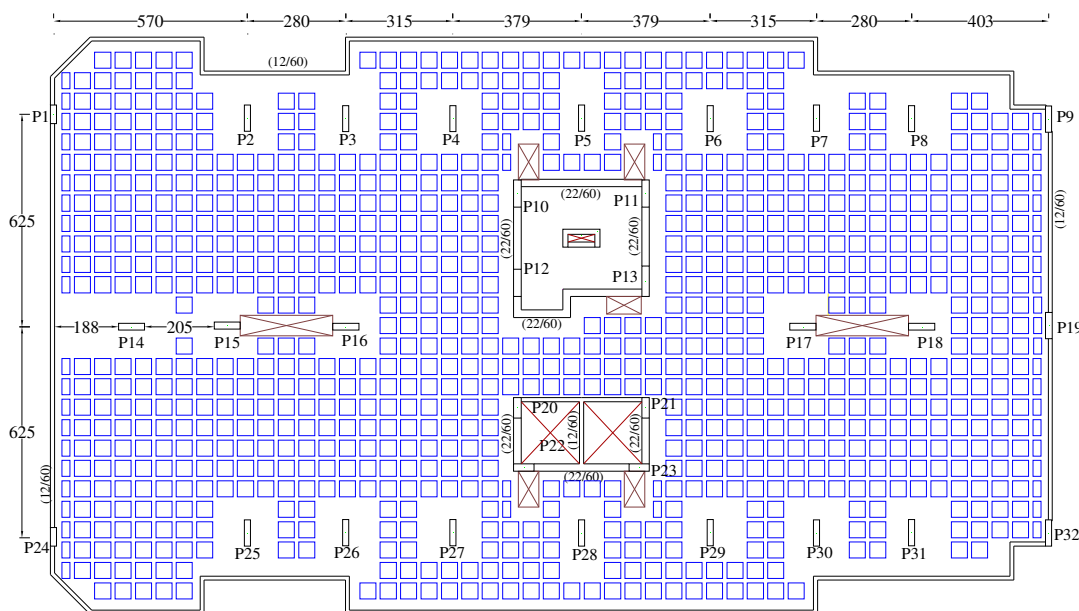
Planta baixa do pavimento Tipo do segundo exemplo
